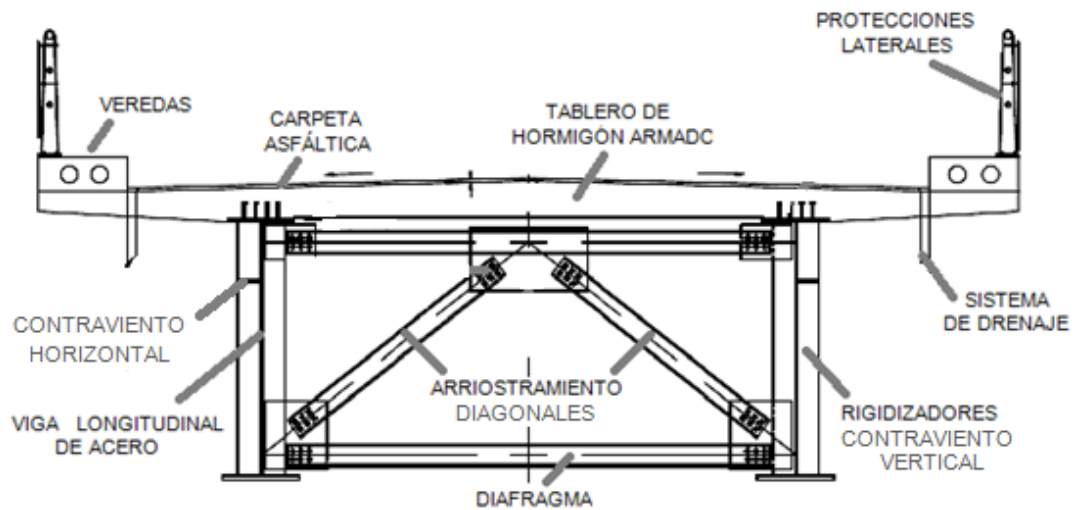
Equipamiento, tablero, elementos principales y secundarios de la superestructura de un puente de vigas armadas de acero [13]
